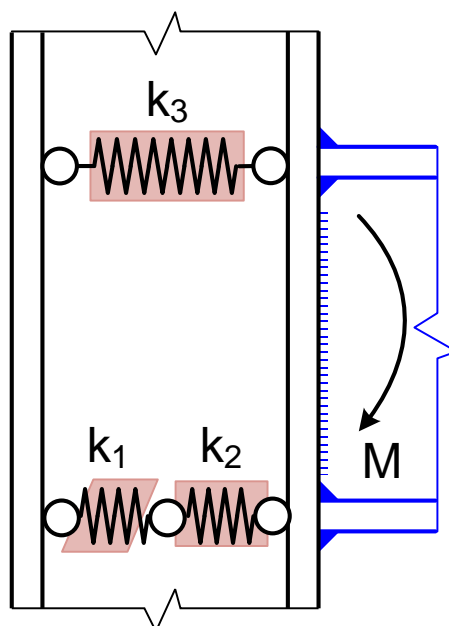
Modelo de rigidez de una unión soldada viga - poste
